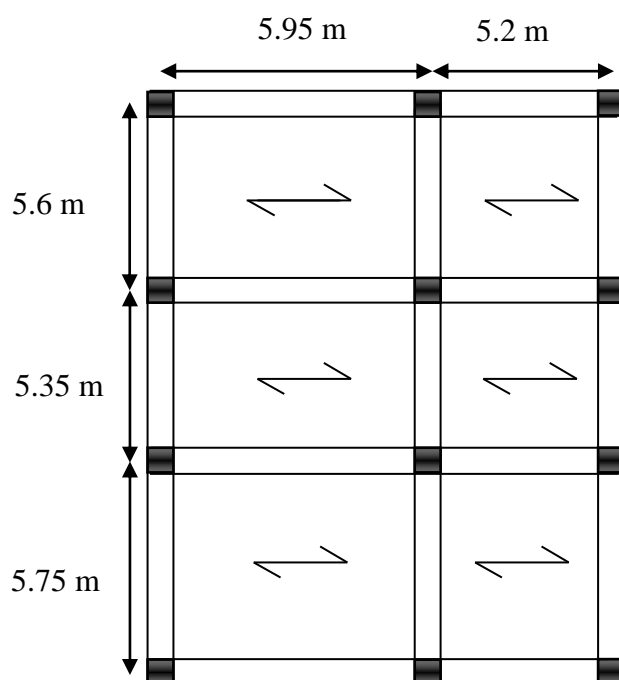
Sens de la disposition des poutrelles de la terrasse accessible
